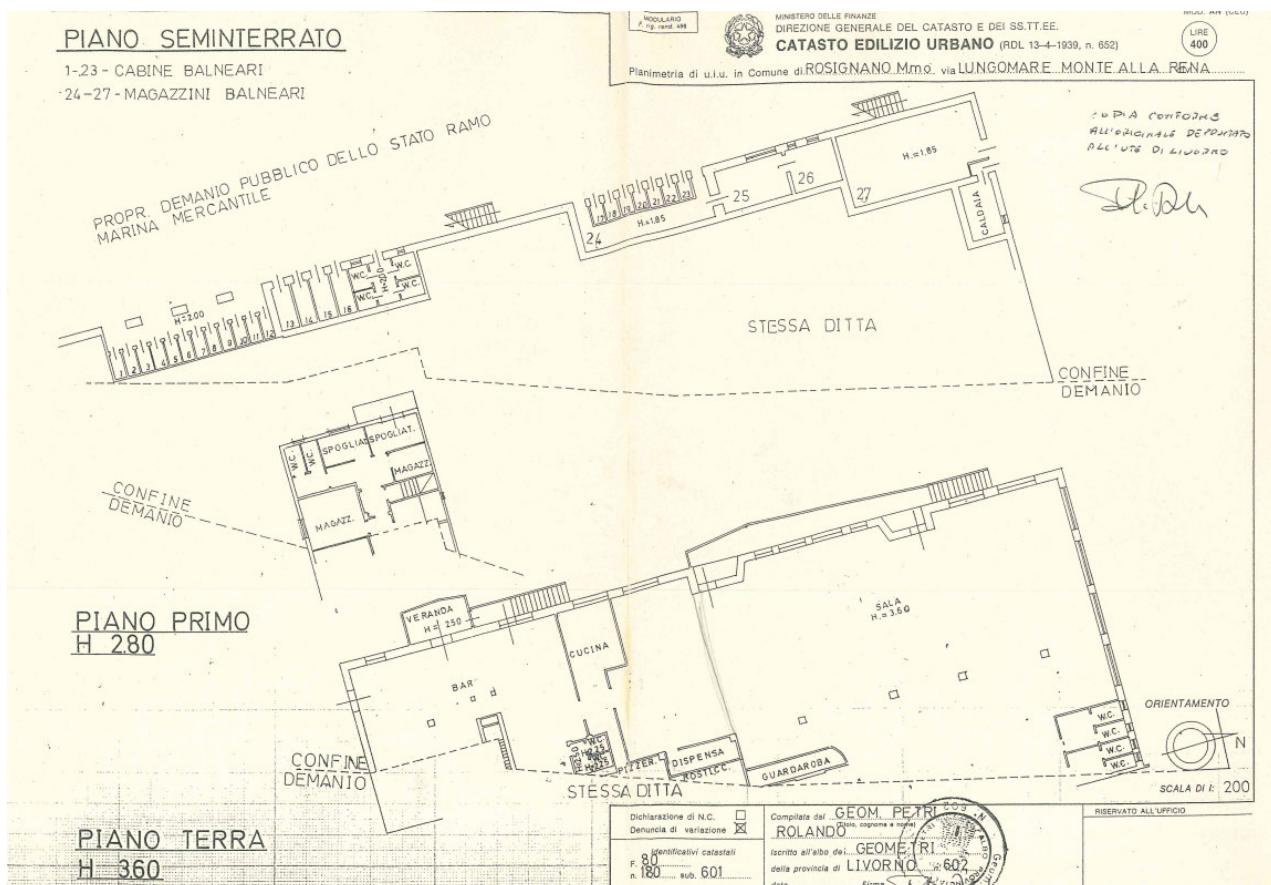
estratto planimetria catastale dell'immobile ex Sirena
